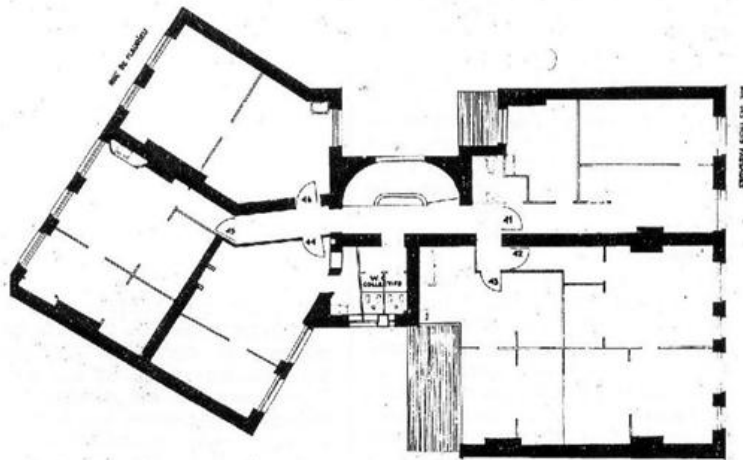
Plan du 4e étage de l'immeuble avant l'intervention
